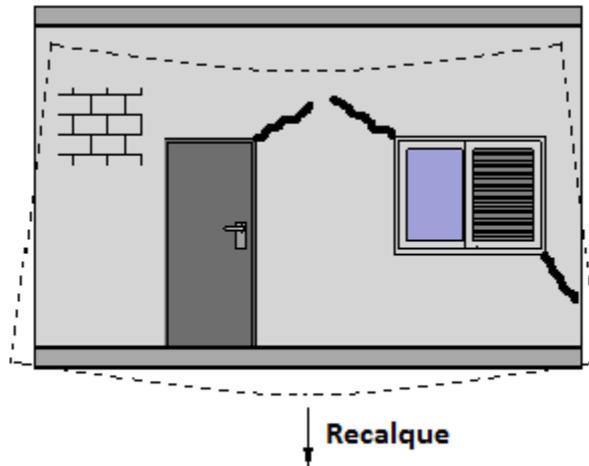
Fissuras verticais causadas por recalques nas fundações.
